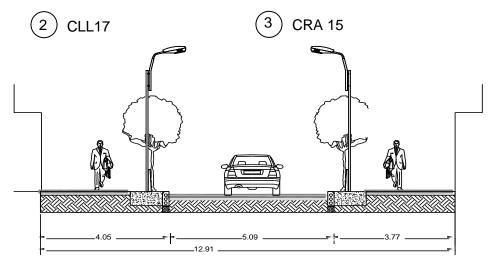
Perfil vial calle 17. Fuente: elaboración propia
